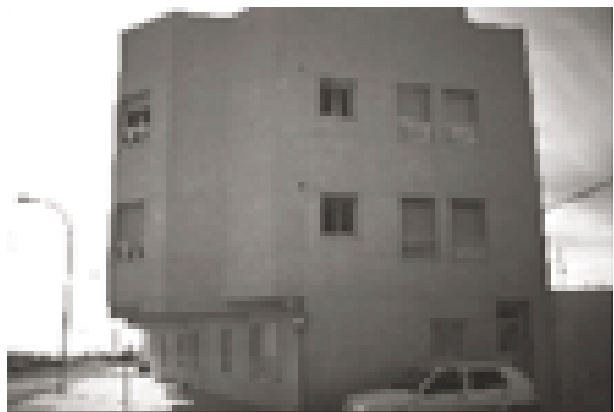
Irregularitat en planta: creixement de les plantes amb l'altura.
